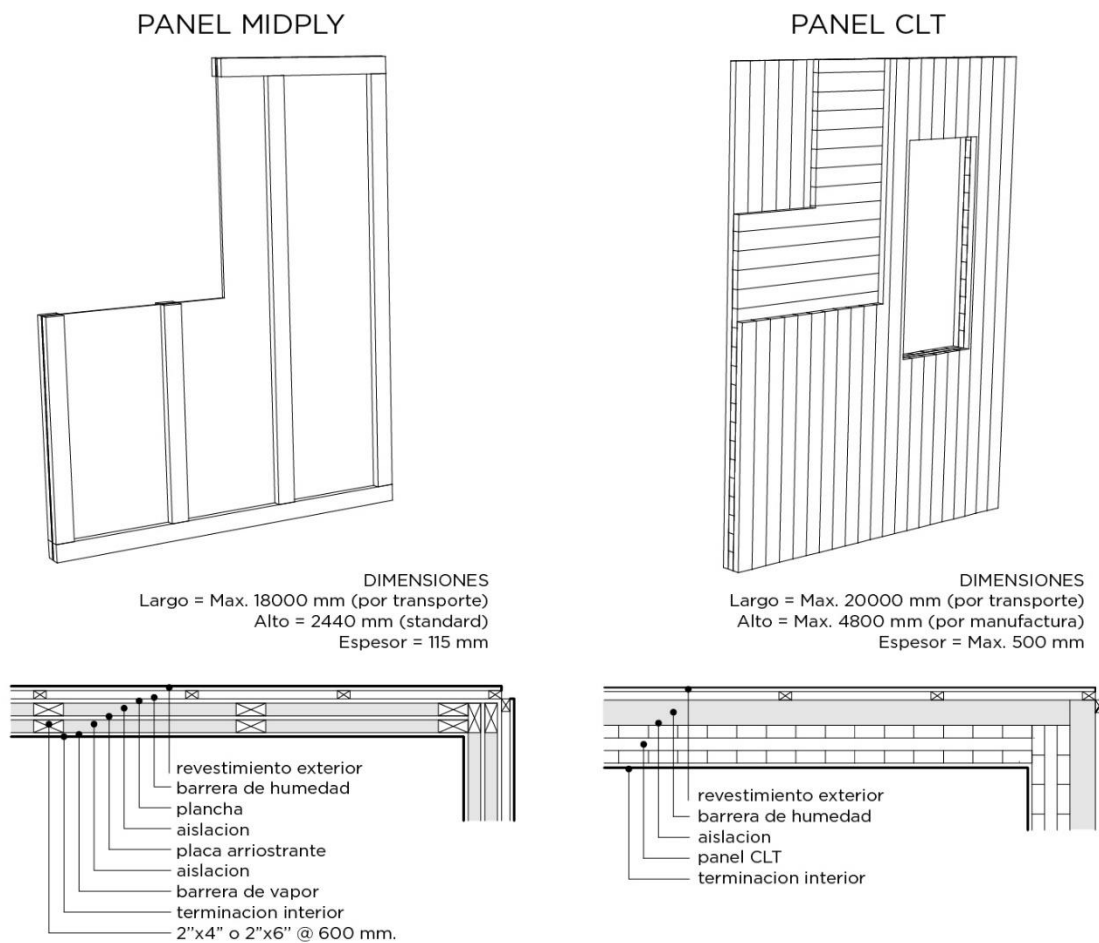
Características generales y detalle constructivo de muro envoltivo de paneles Midply y CLT.
